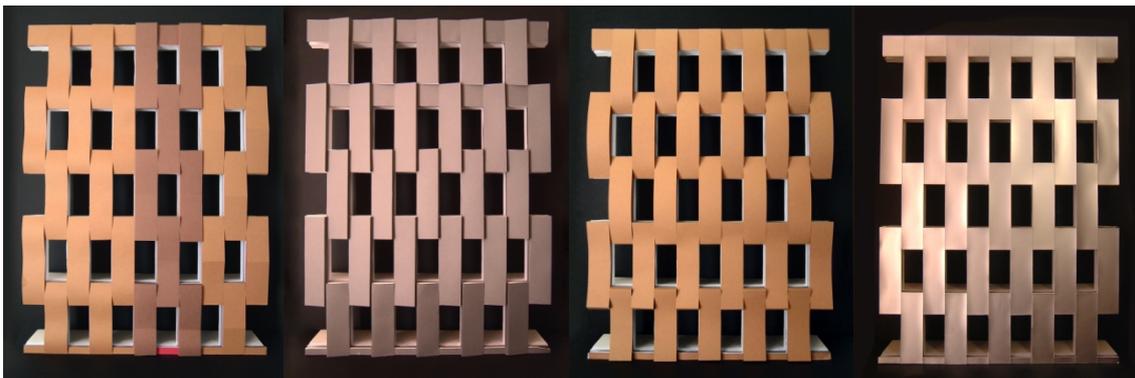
Maquetes de estudo da fachada do Conjunto de La Pallaresa
